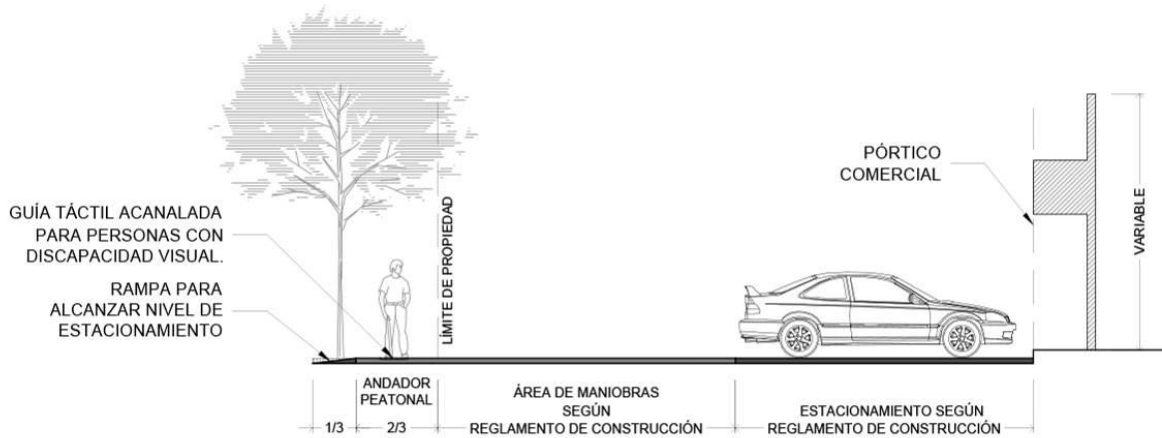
Detalle de banqueta y estacionamiento en zona comercial
